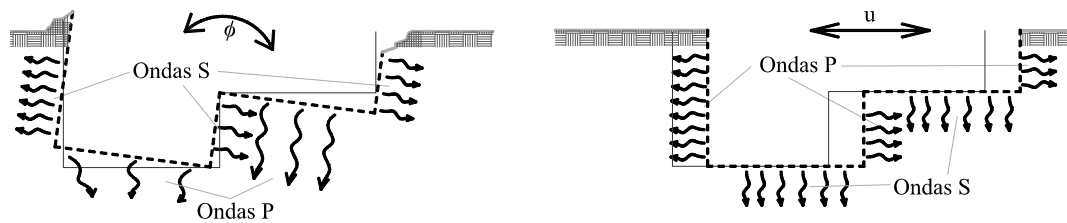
Ondas generadas por cabeceo (izquierda) y vibración horizontal (derecha) de la cimentación, vista en elevación.
